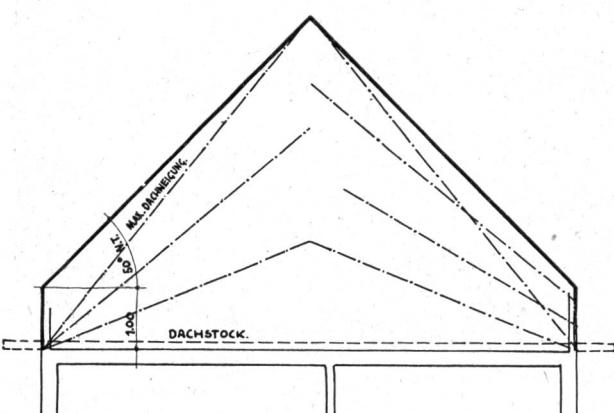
Darstellung der vorgeschriebenen Dachneigungen, § 18.
